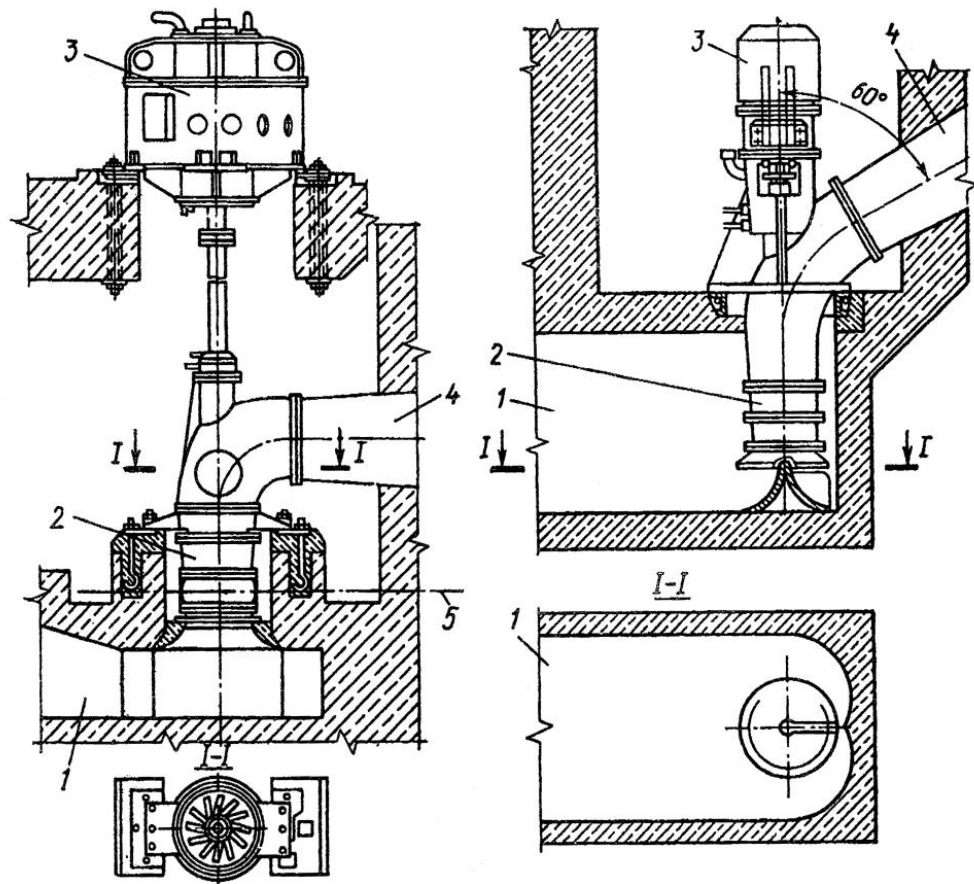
конструкція осьового насоса з поворотними лопатями
